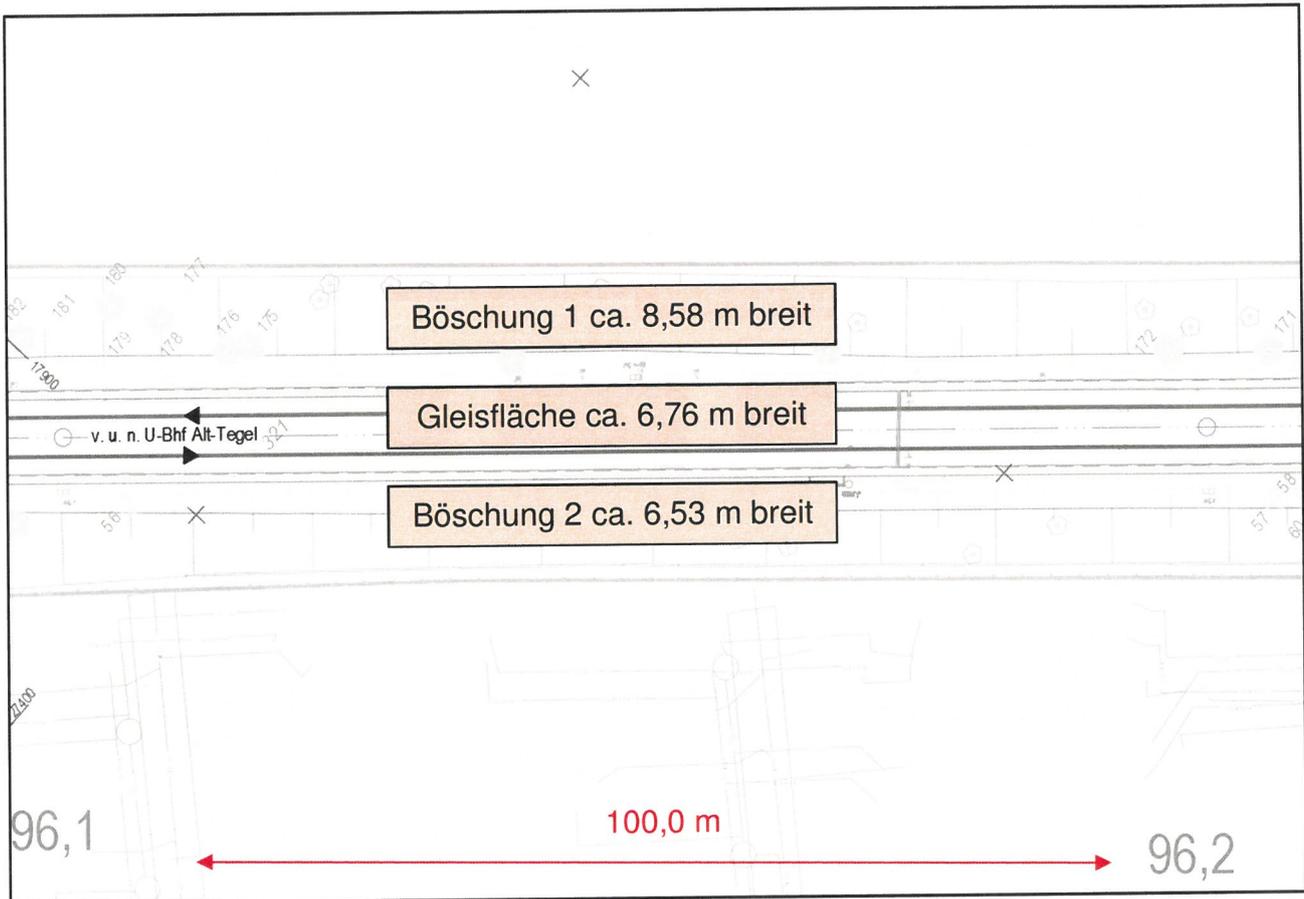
Betrachtungsgebiet, exemplarisch 100 m Ausschnitt aus Lageplan
